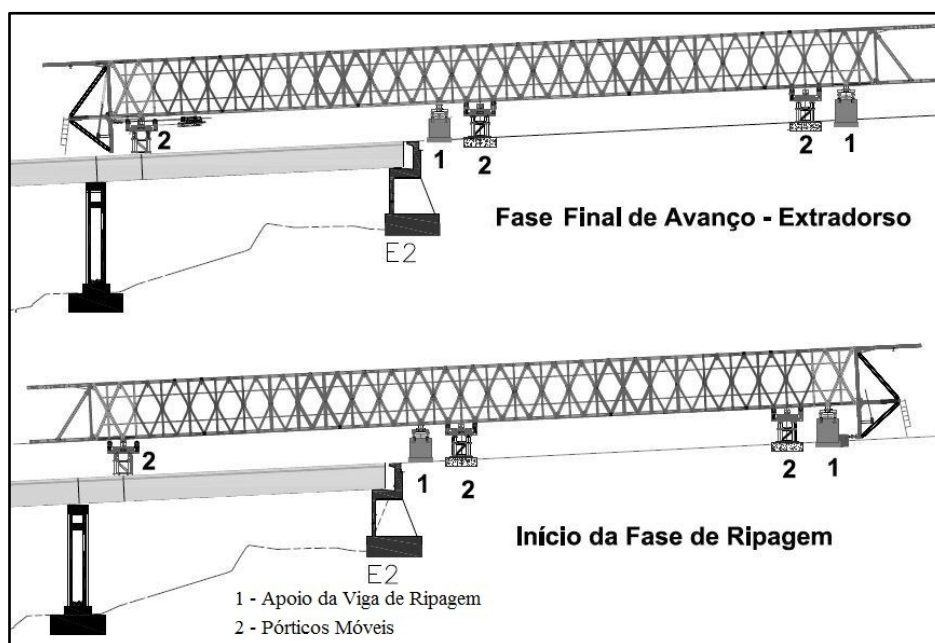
Corte longitudinal da fase final de avanço e da fase inicial ripagem
